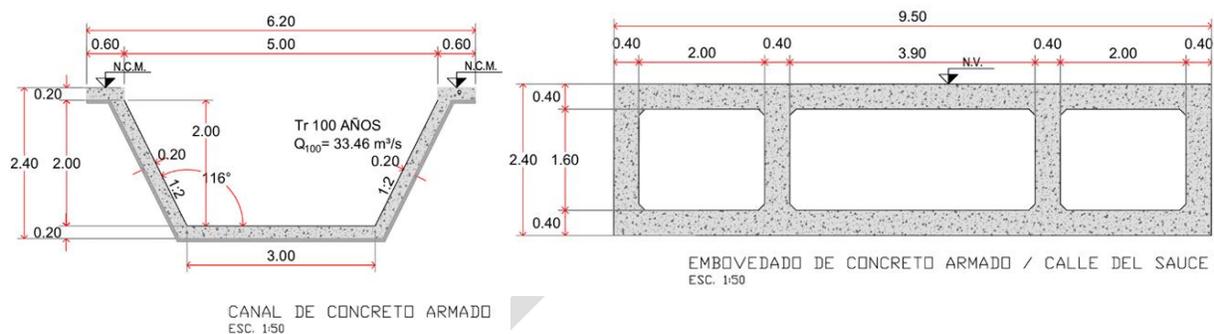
Detalles de la sección del canal y del embovedado del Proyecto.
